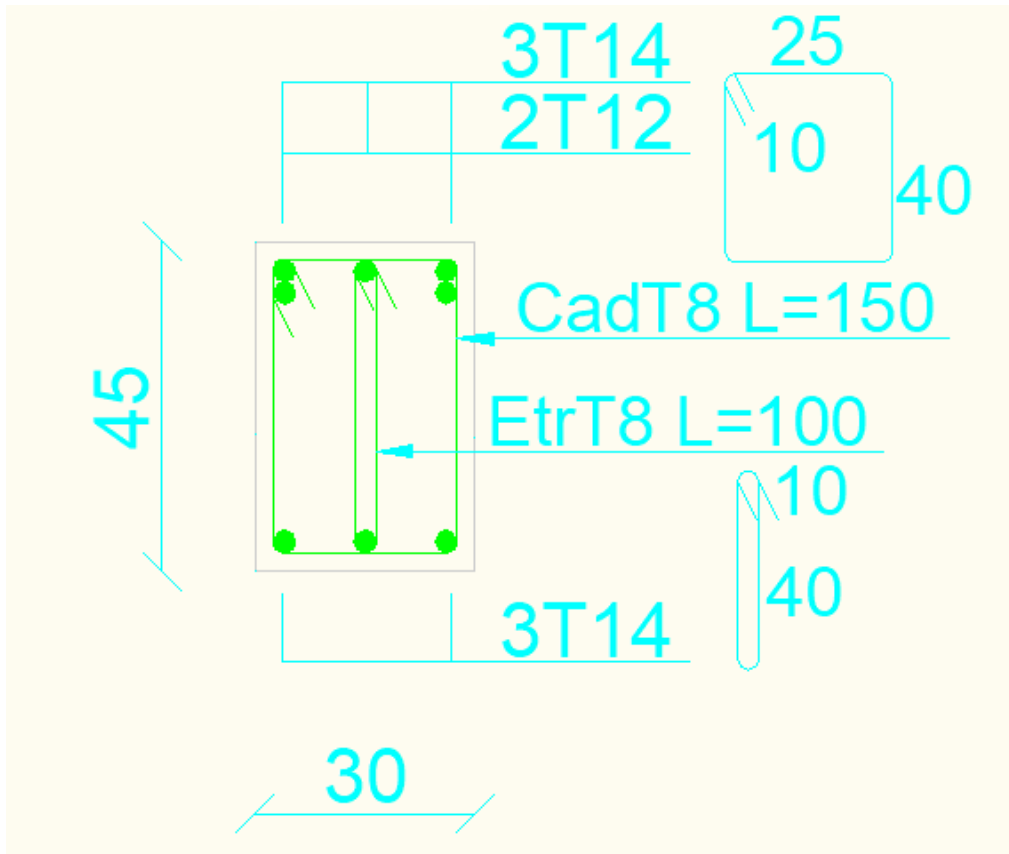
Schéma de ferrailage poutre principale reposant sur voile Niv 3 en appuis et travée.
